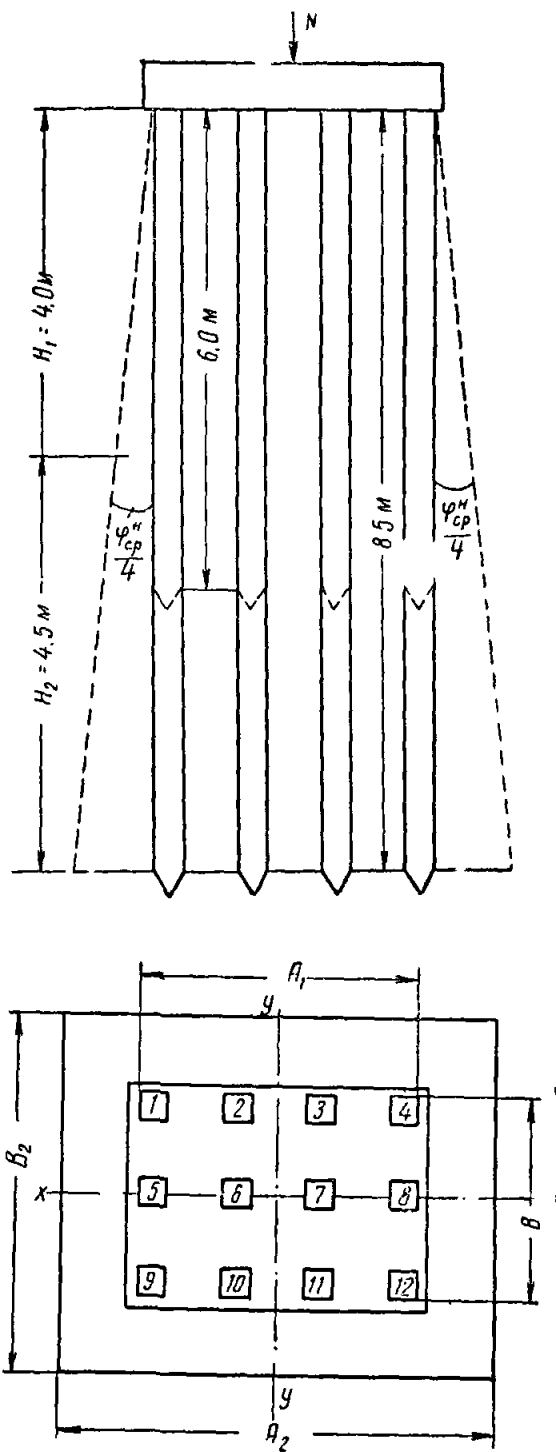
План и поперечный разрез свайного фундамента к примеру 8
